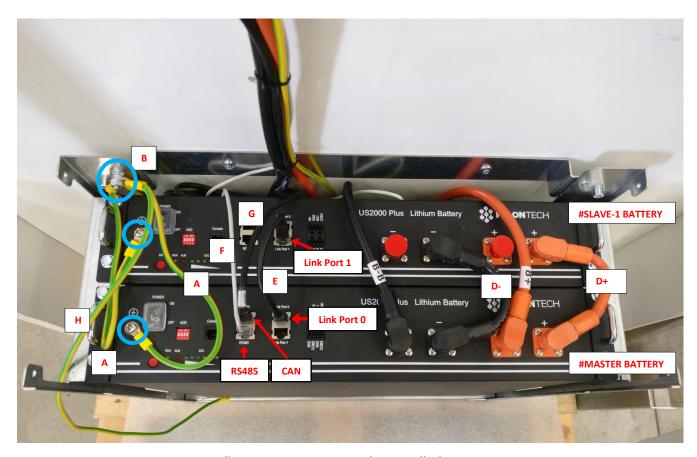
Collegamenti necessari quando si installa il WALL-BOX-Bx BASE
